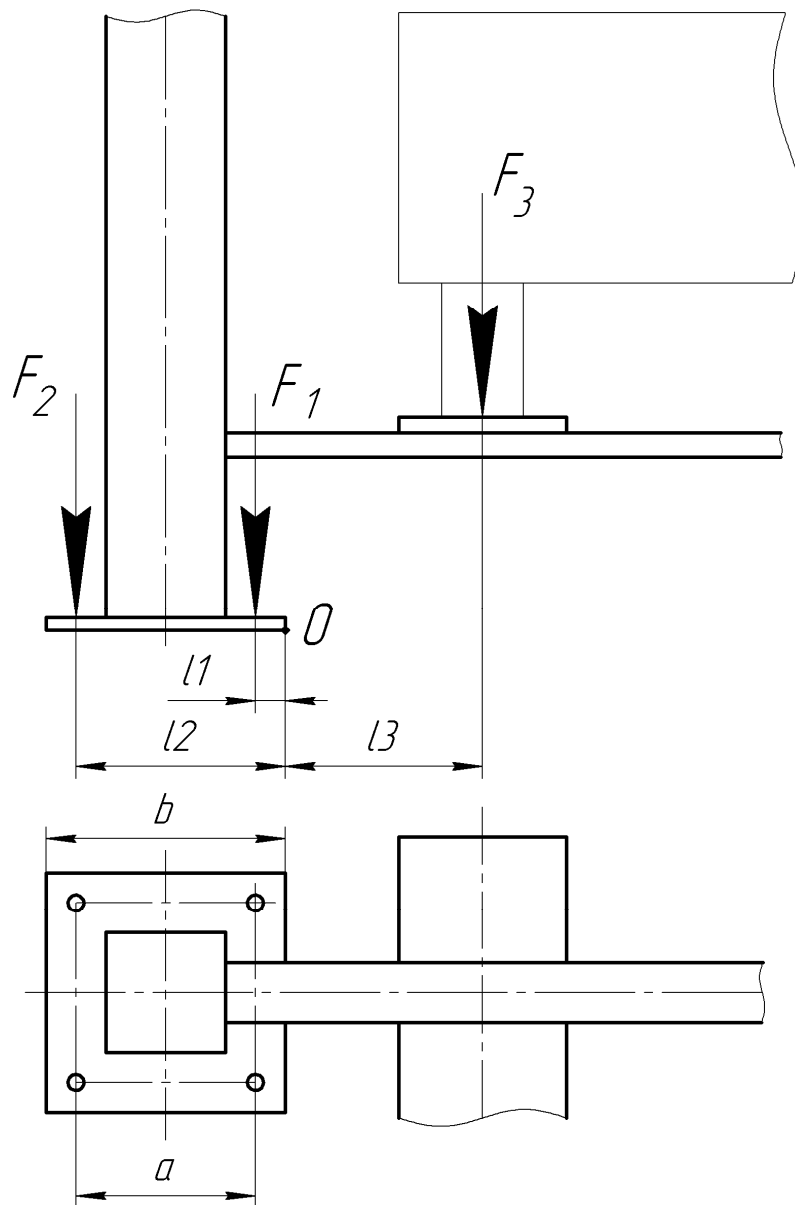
Расчетная схема для расчета фундаментных болтов
